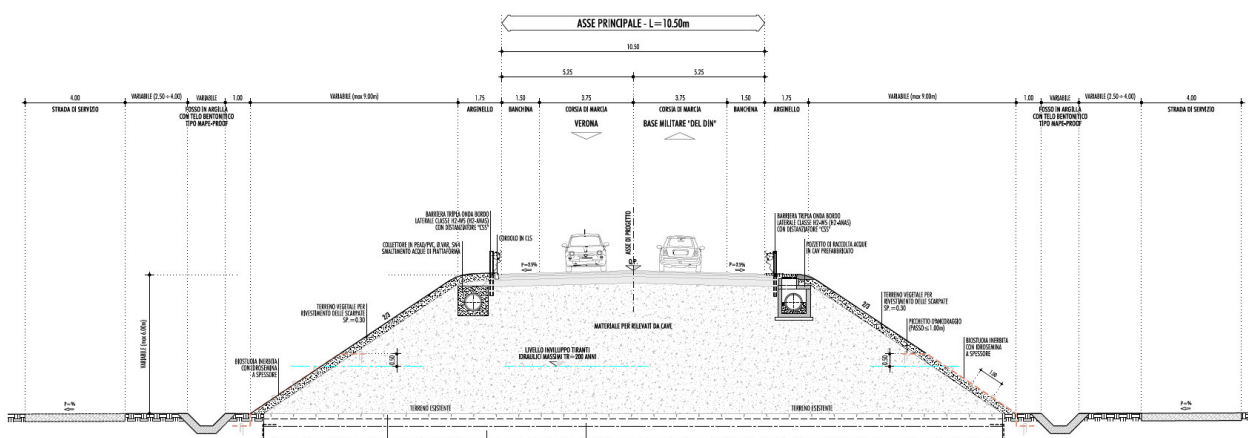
SEZIONE TIPO IN RILEVATO DELL'ASSE PRINCIPALE
